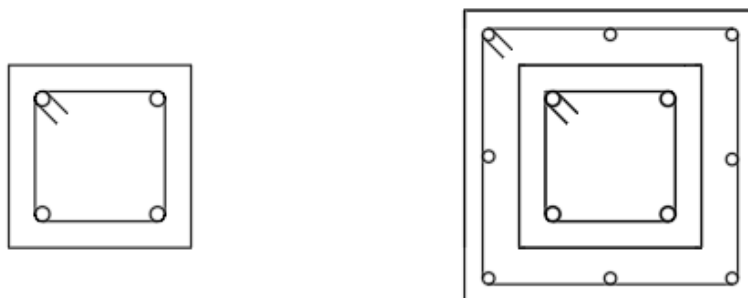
Sección pilar 1 antiguo (izquierda), pilar recrecido (derecha).
